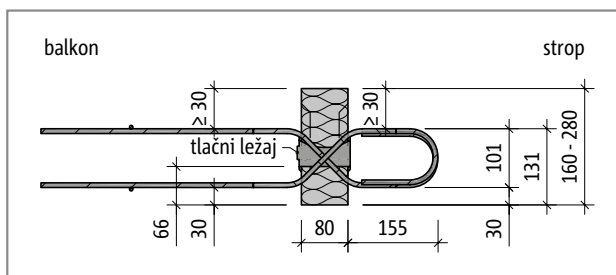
Schöck Isokorb® tip QP60M: tloris proizvoda
